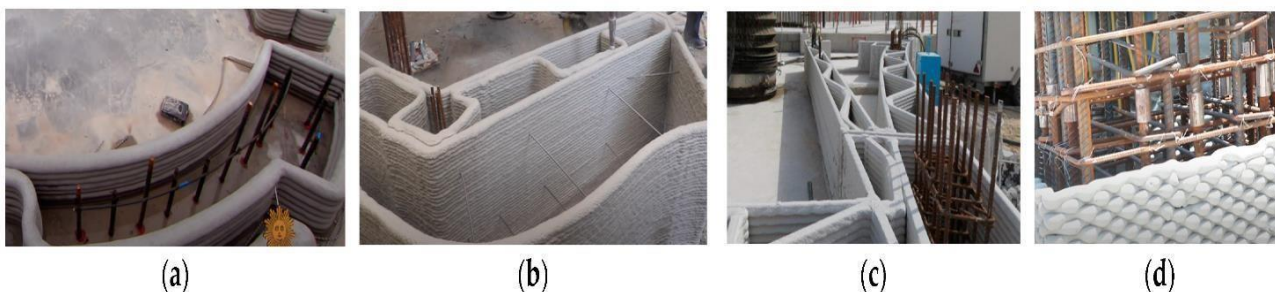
Способи армування для 3DPC, що використовується в будівельних конструкціях на місці: а - вертикальні арматурні стержні, зв'язані вигнутою горизонтальною арматурою в криволінійному елементі стіни (ICON), б - вертикальні арматурні стержні з фасонними зв'язками в елементі стіни (CyBe), с - зосереджена арматура в елементі стіни (ICON); д - зосереджена арматура, з'єднана арматурними з'єднувальними елементами в елементі колони (WinSun)
